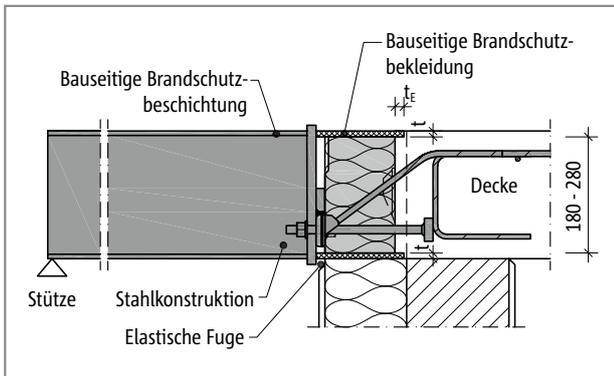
Schöck Isokorb® XT Typ SQ: Bauseitige Brandschutzbekleidung für den Isokorb®, brandschutzbeschichtete Stahlkonstruktion; Schnitt
